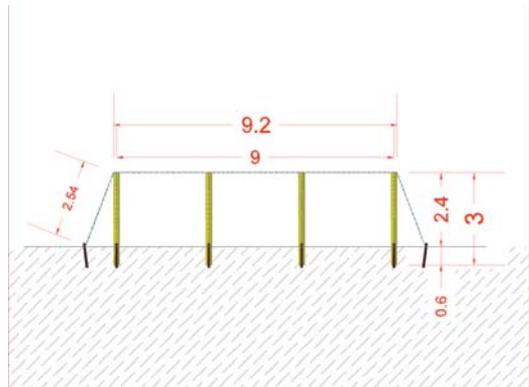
Vista Planta Perfil frontal de la estructura de soporte. Diseño CREDyCOM
